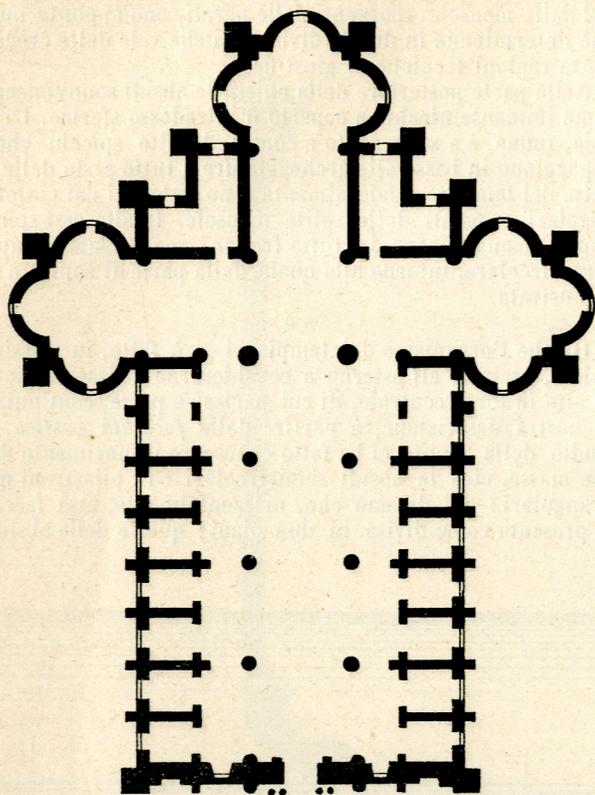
Certosa di Pavia. Pianta della Chiesa.
